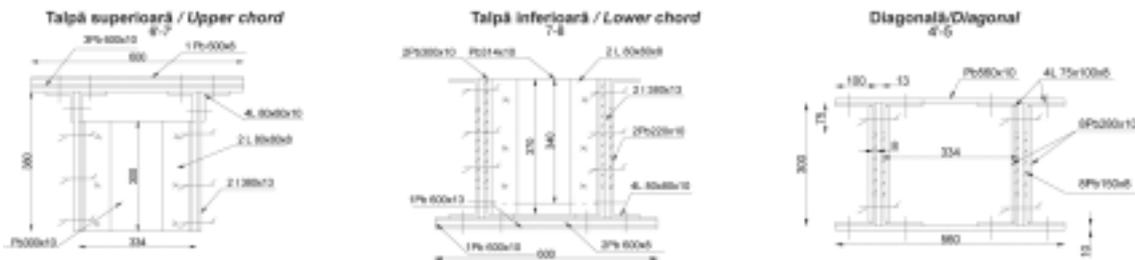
Secțiunile transversale ale elementelor grinzilor principale/ *Figure 17. Double-plane truss members
